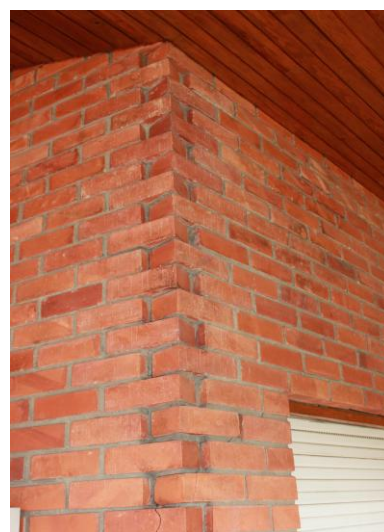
Detalhe da disposição do tijolo num cunhal de paredes não ortogonais.
